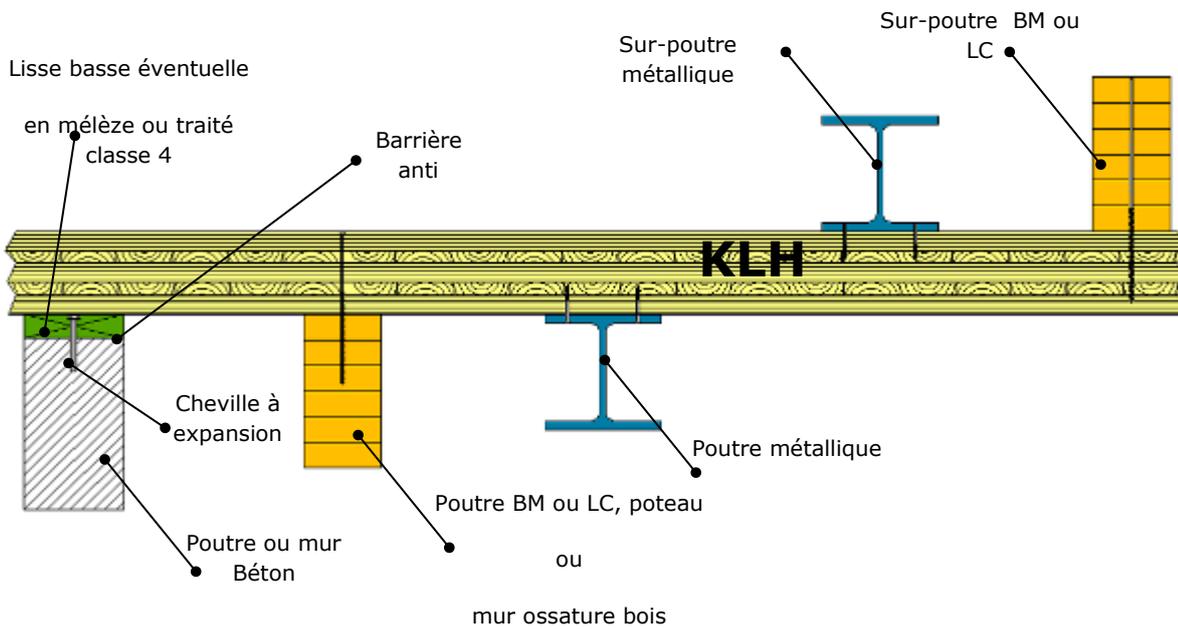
Autre Type d'appui usuels sur plancher KLH
